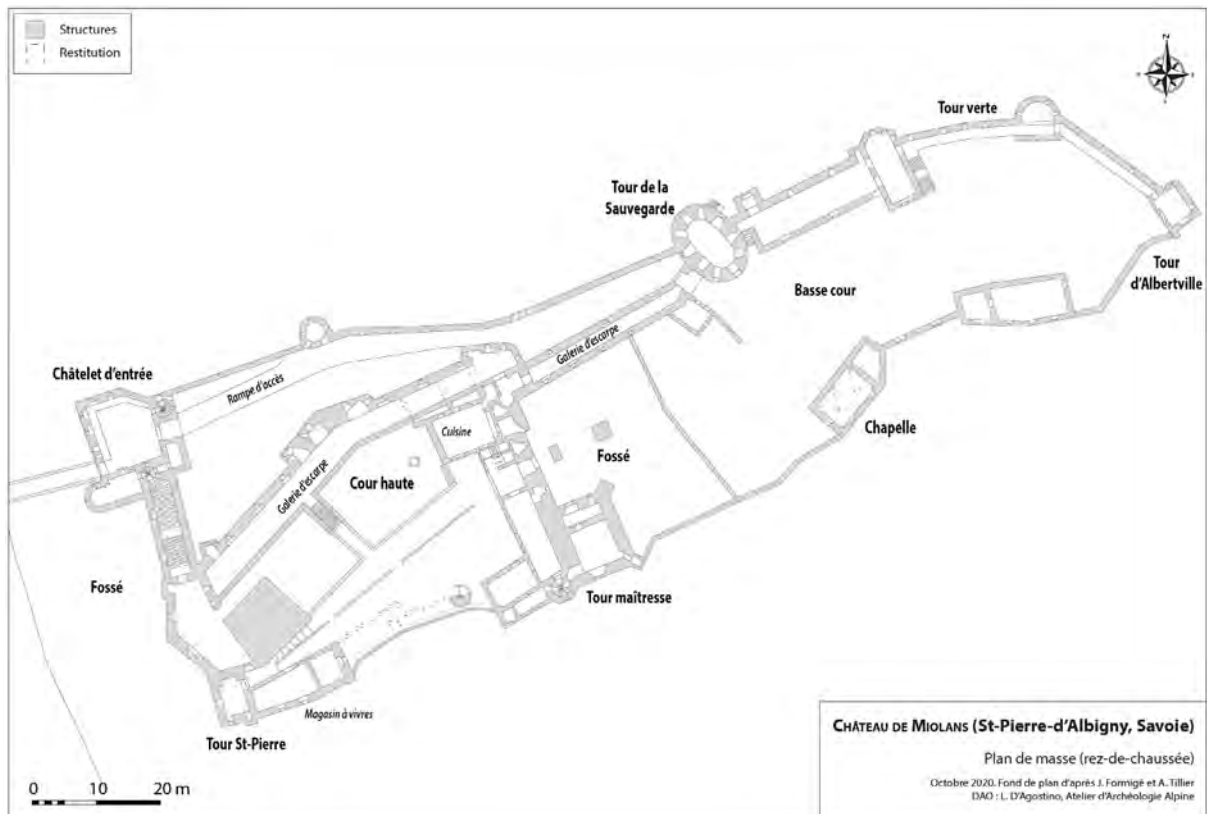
Château de Miolans. Plan général du site. Doc. : L. D'Agostino
